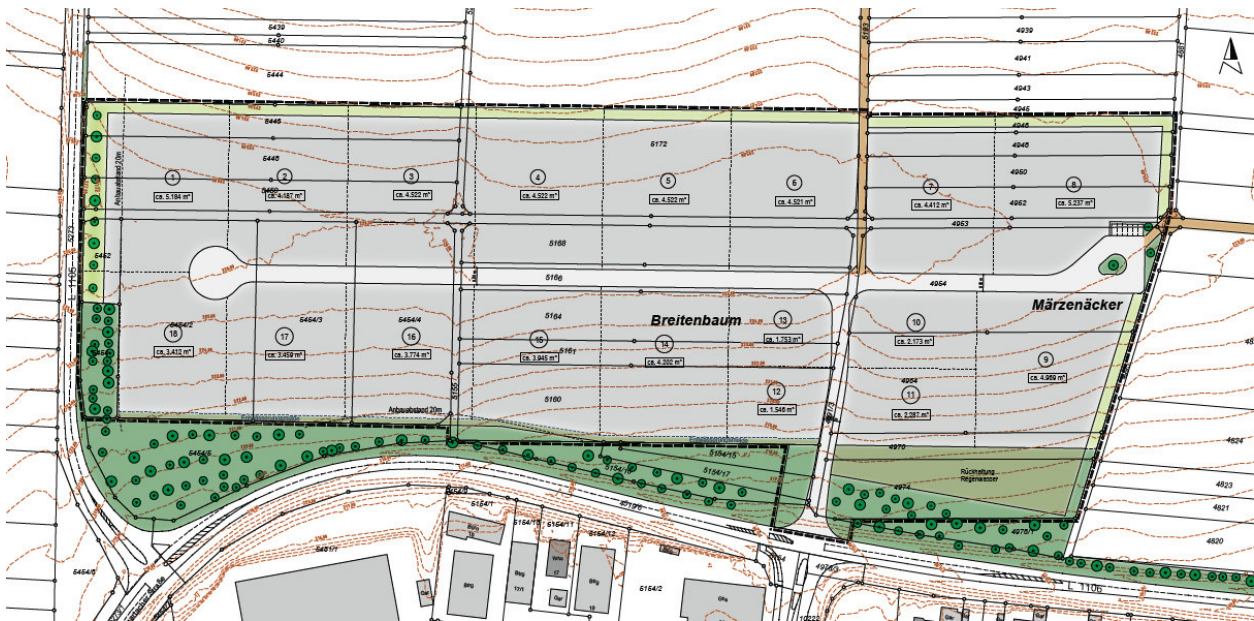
Lageplan zur Erschließung des geplanten Gewerbegebiets „Breitenbaum“ (Quelle: KÄSER INGENIEURE GMBH + CO. KG).
